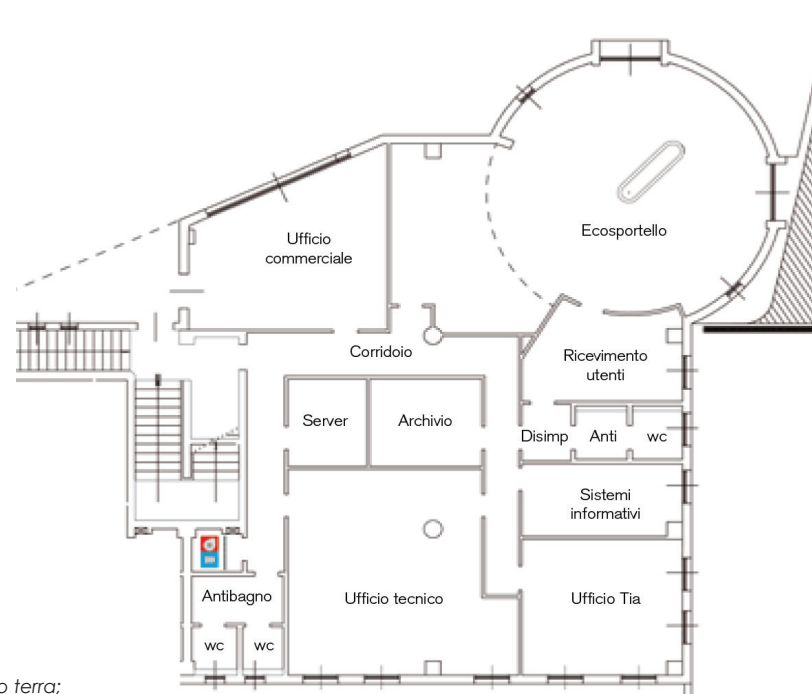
Pianta piano terra; Fonte: <http://www.savnoservizi.it/>;
